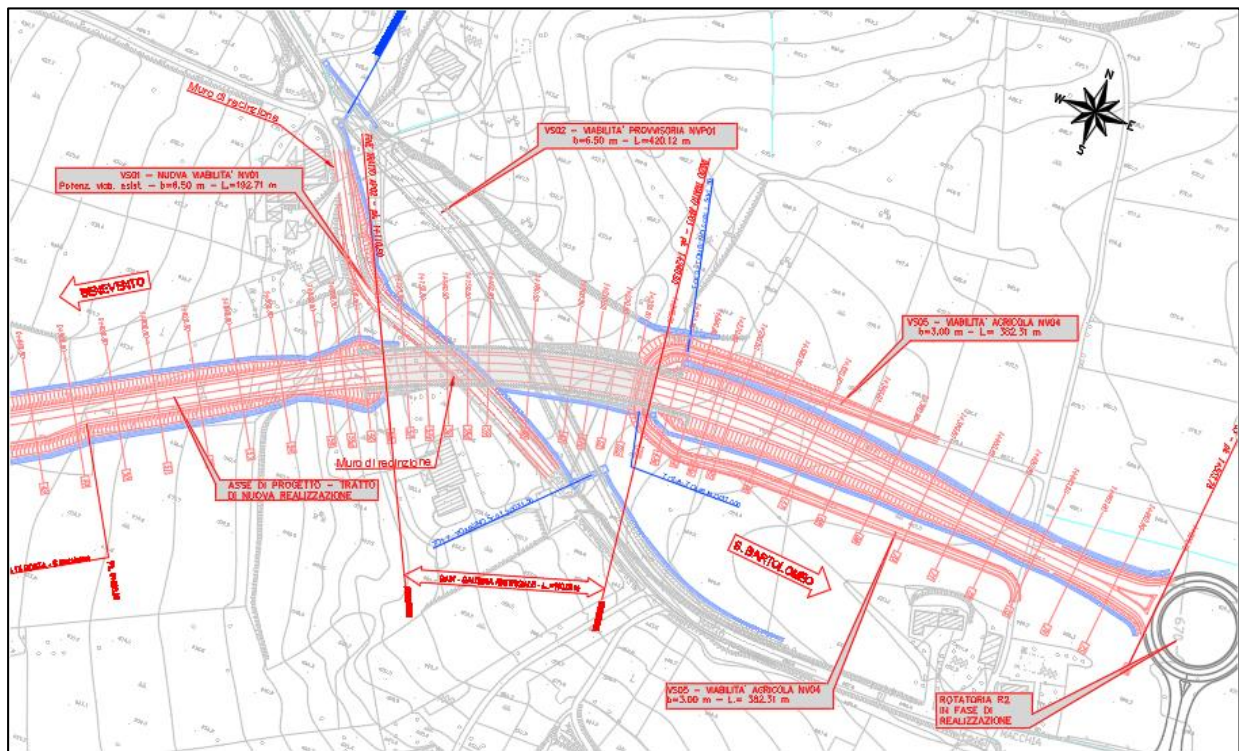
Stralcio galleria - Planimetria di progetto
